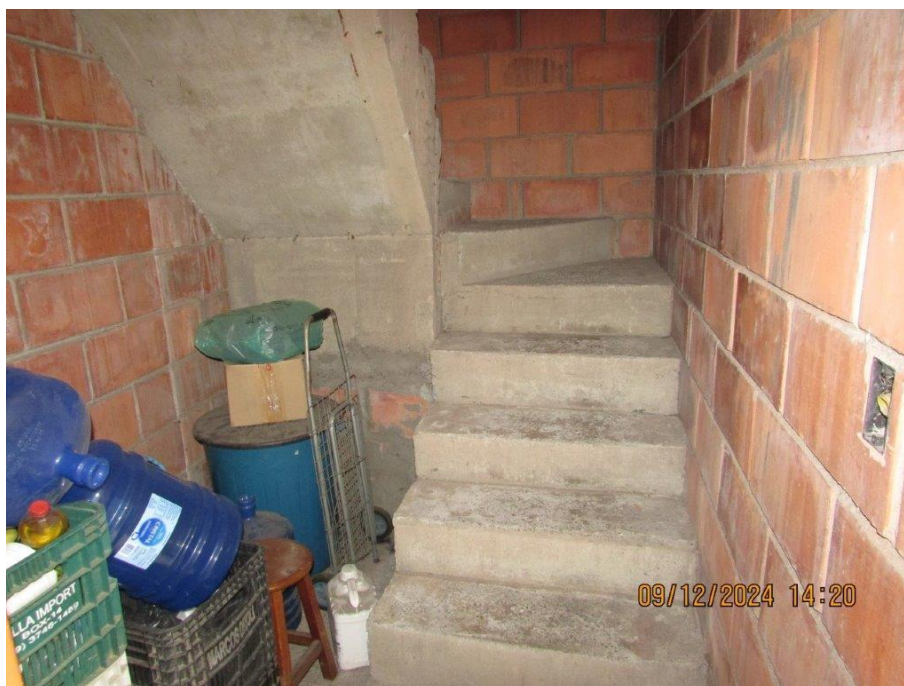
Vista parcial da escada, acesso ao 2º Pavimento
